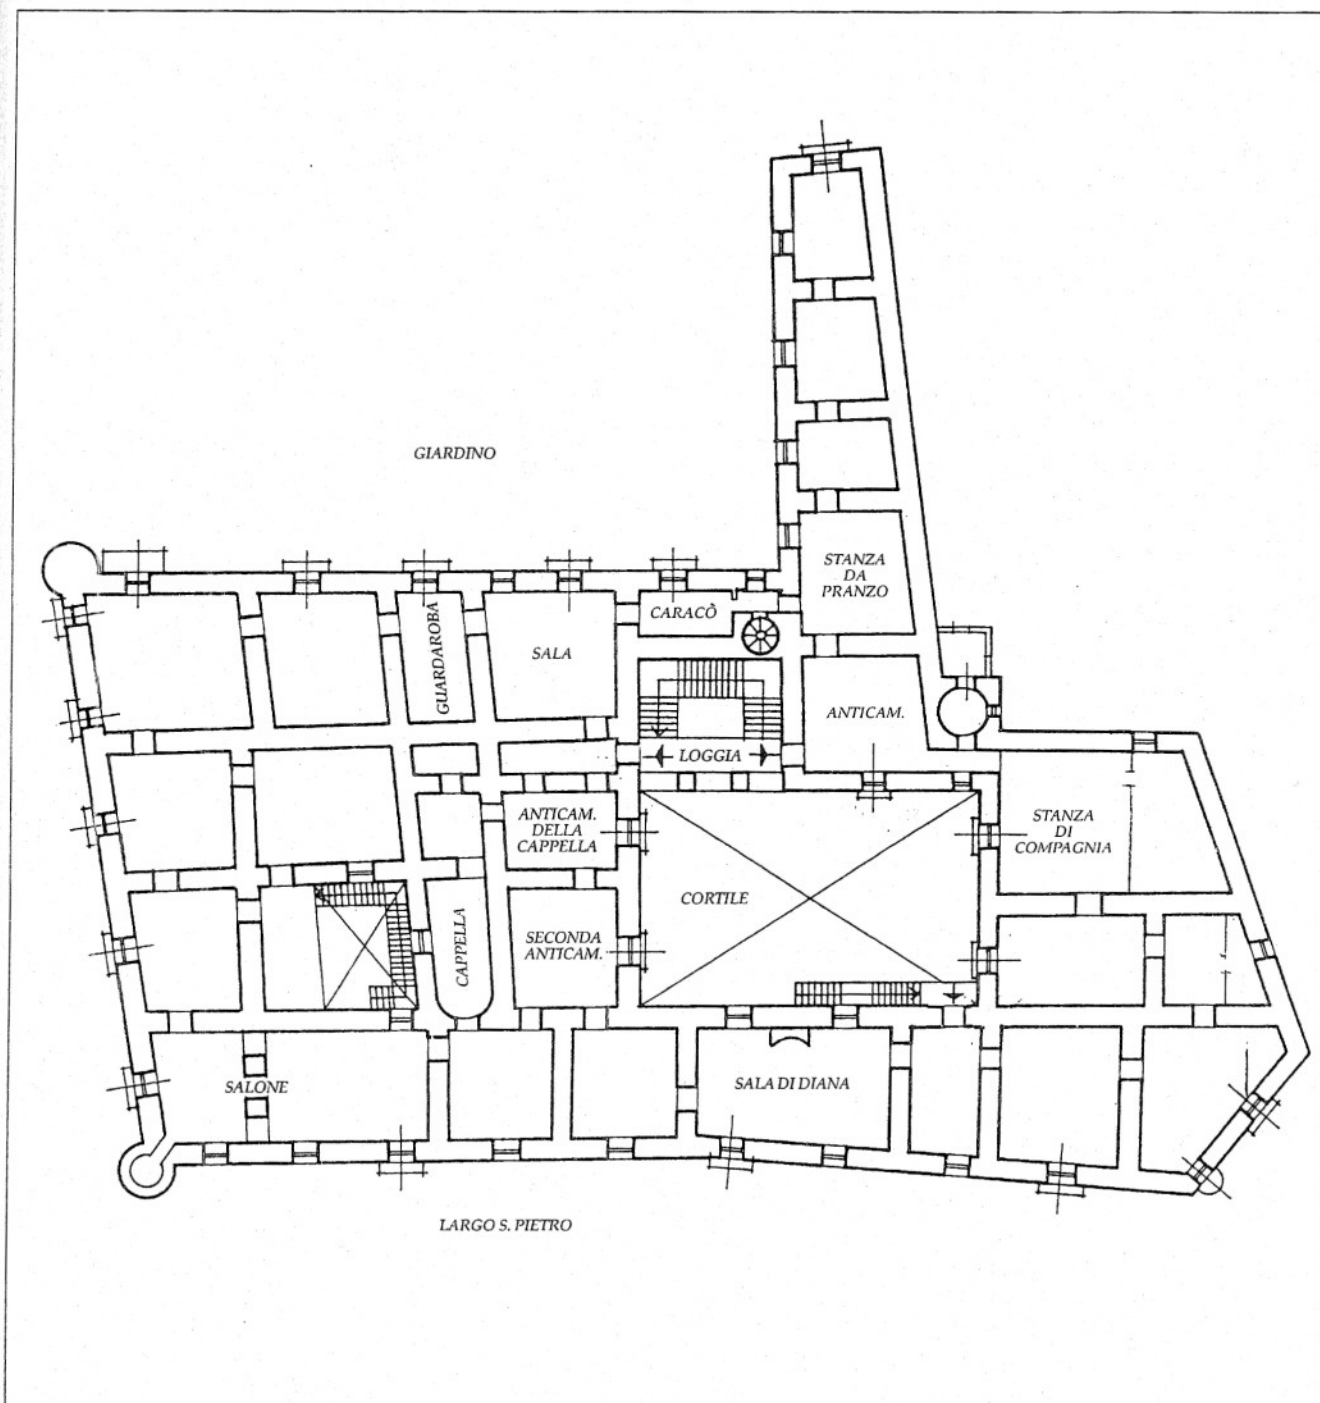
Pianta del piano nobile nelle strutture originarie, prima dei successivi adattamenti. La suddivisione e la nomenclatura degli ambienti è tratta dagli Atti del 1798 (in Arch.)
